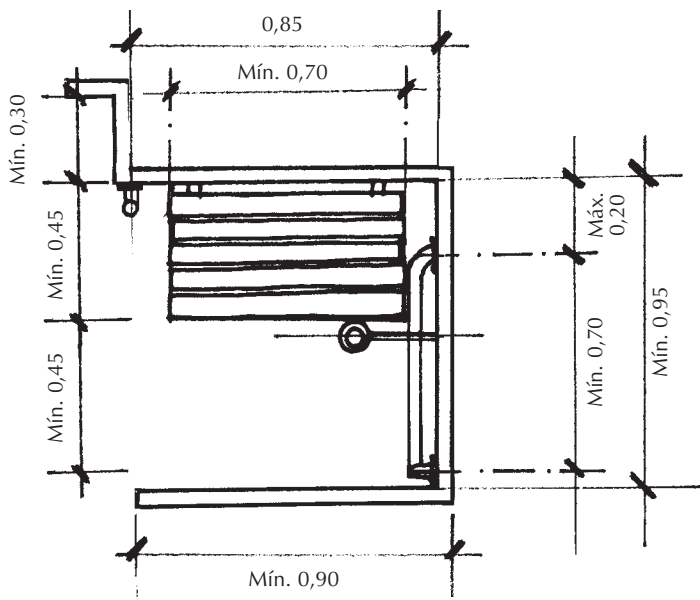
Vista superior do boxe do chuveiro com barra horizontal e em "L"
